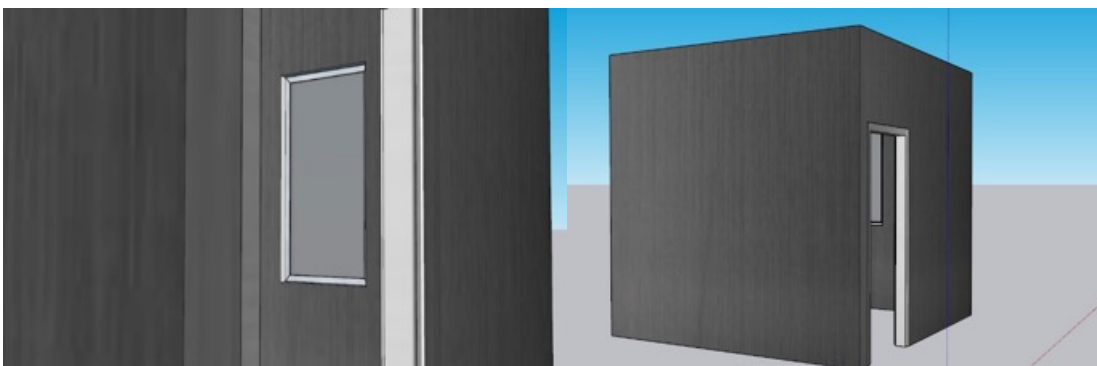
Plano de la cabina metálica. Fuente: Elaboración propia, 2022.
